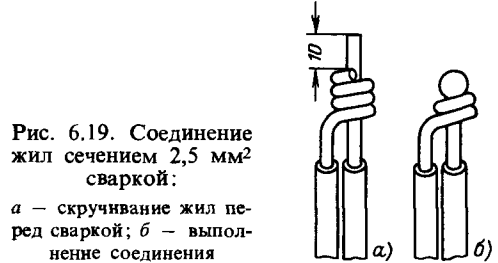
Соединение жил сечением 2,5 мм<sup>2</sup> сваркой:
